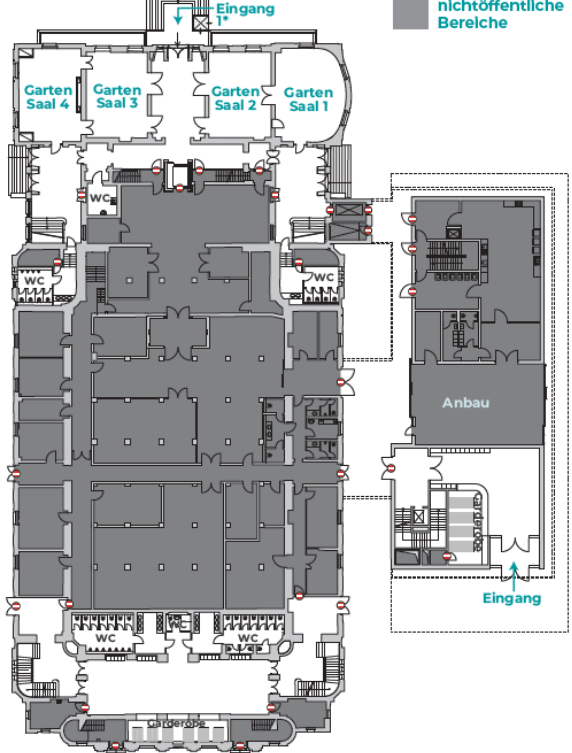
Grundrisse Untergeschoss und Erdgeschoss
